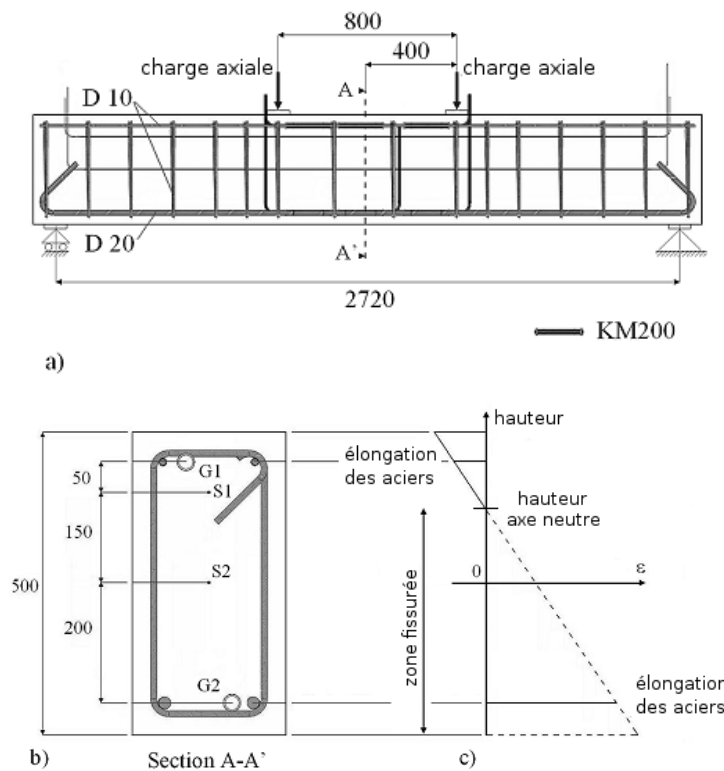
(Haut) Instrumentation de la poutre pour les mesures de déformations. (Bas) Position de l'axe neutre d'une poutre en béton fissurée.
